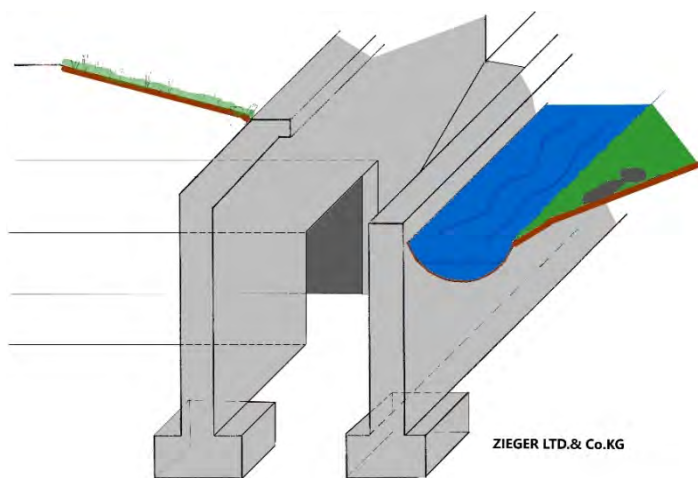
Prinzip des Stelztunnelsegment mit Doppelwand
